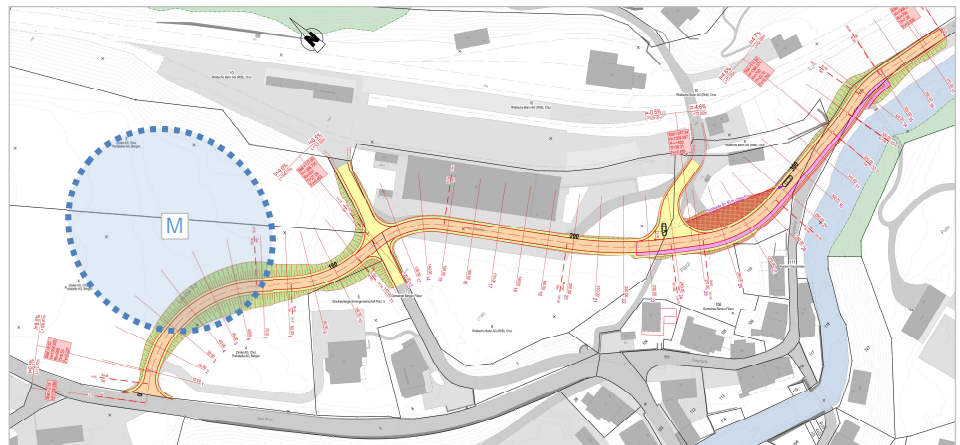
Auszug Situationsplan Stuglserstrasse, 28.11.2025
